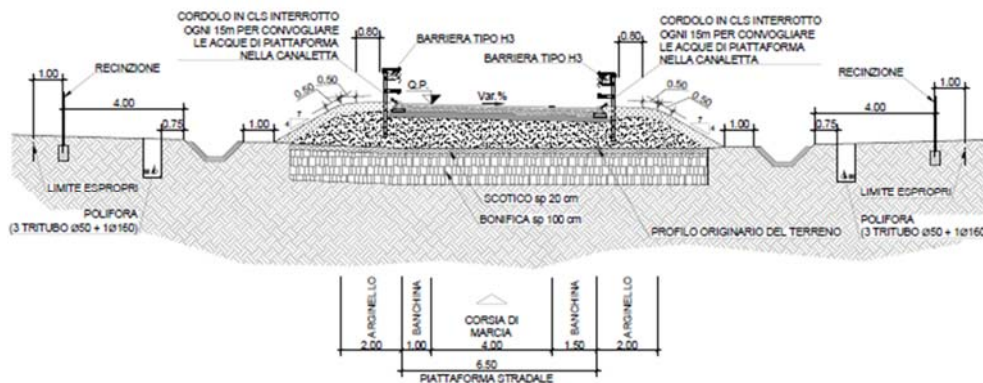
Sezione tipo rami di svincolo in rilevato rampa monodirezionale
